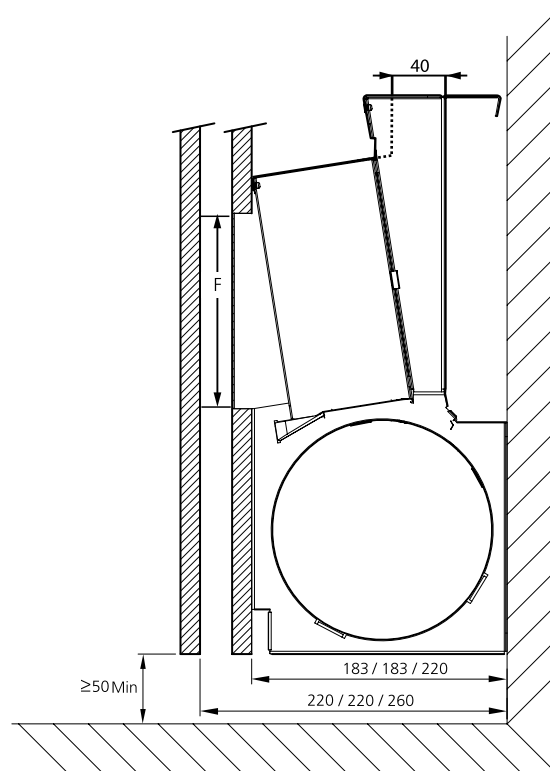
Apertura dell'aria secondaria. Distanza minima tra il pavimento e l'alloggiamento o l'apertura per il ricircolo dell'aria nel pannello frontale.
